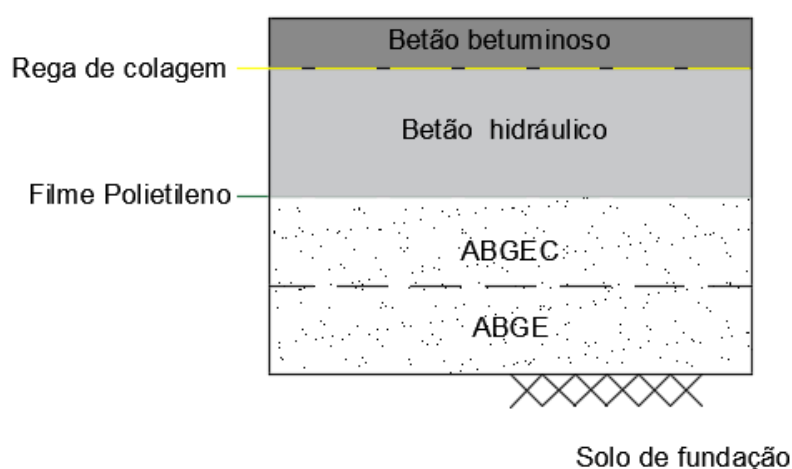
Exemplo da estrutura de um pavimento semirrígido.
